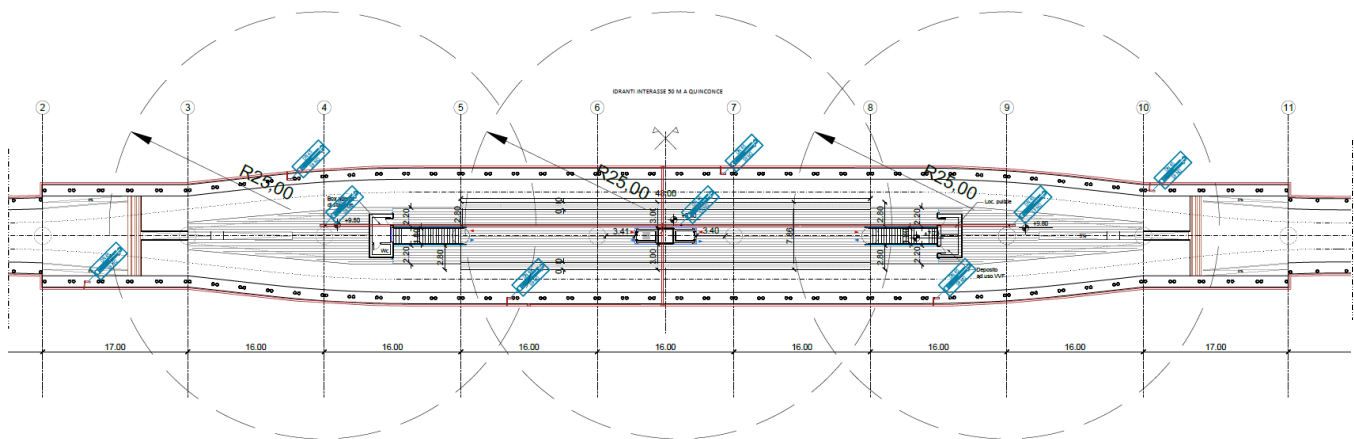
Pianta rete idranti e raggi di influenza banchina stazione tipo
